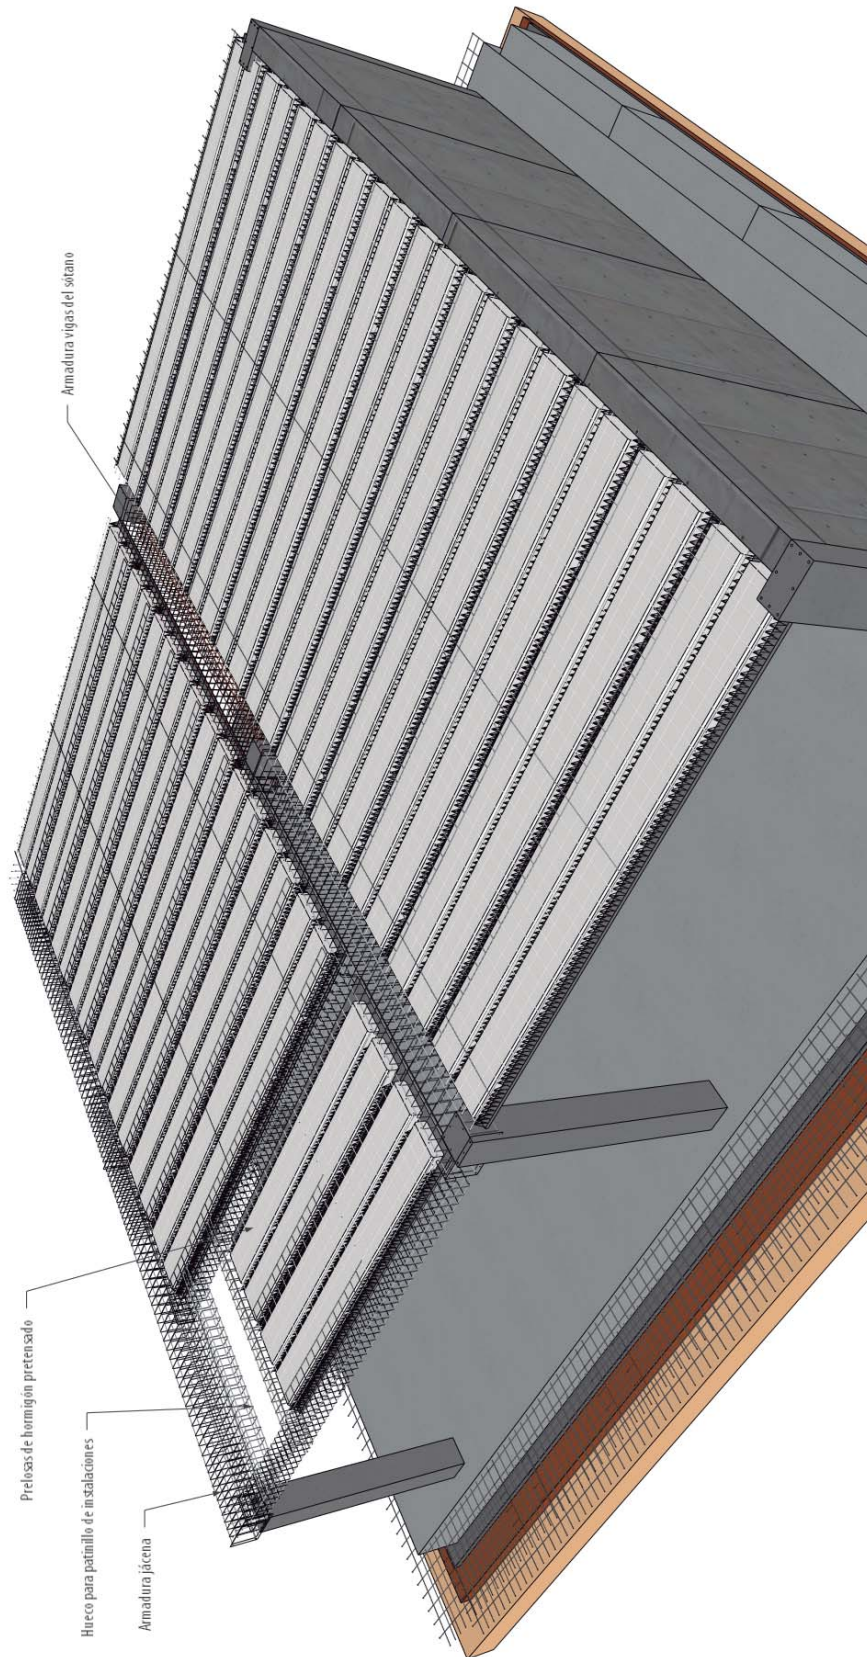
Colocación de las prelosas del forjado de la planta sótano, y las armaduras de las vigas
